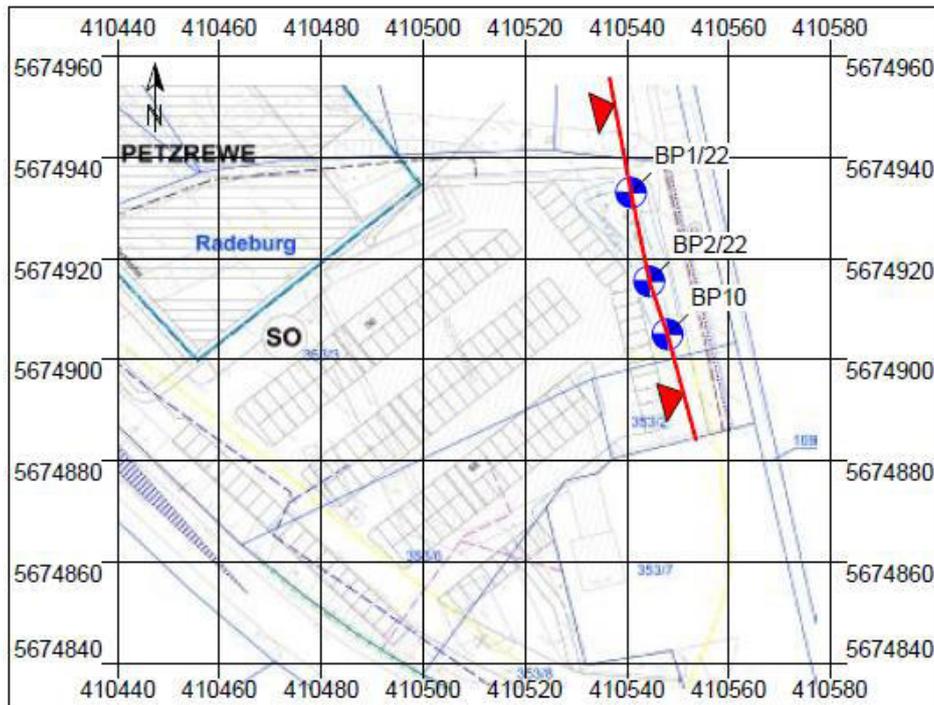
Lage der neuen Bohrungen. Quelle: UP 2: Ergänzende Baugrunduntersuchung zur Regenwasserversickerung
